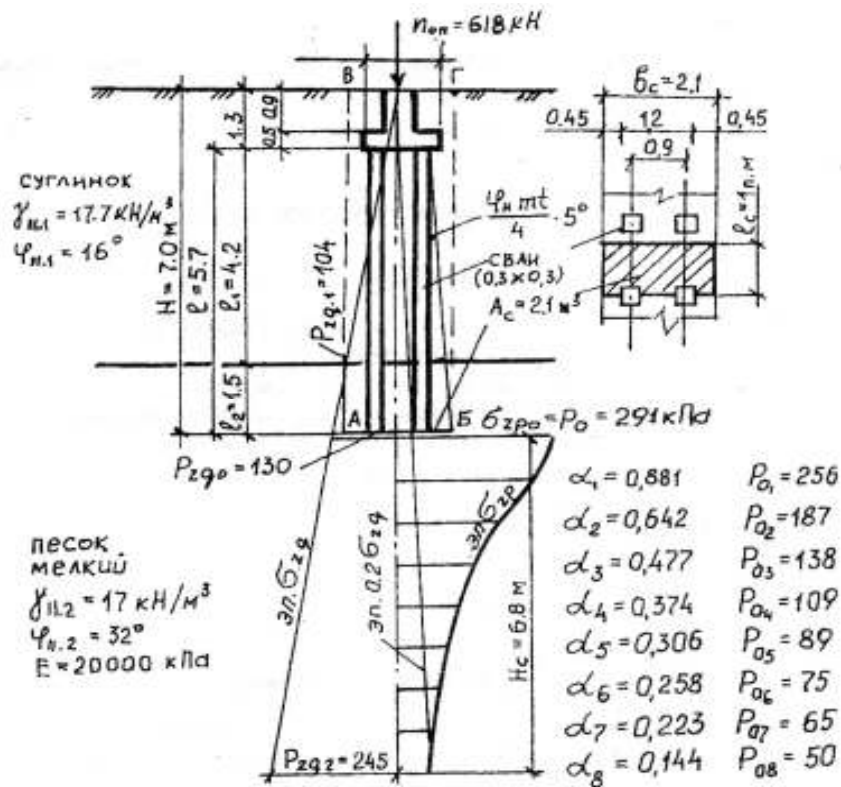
Расчетные схема к определению осадки свайного фундамента
